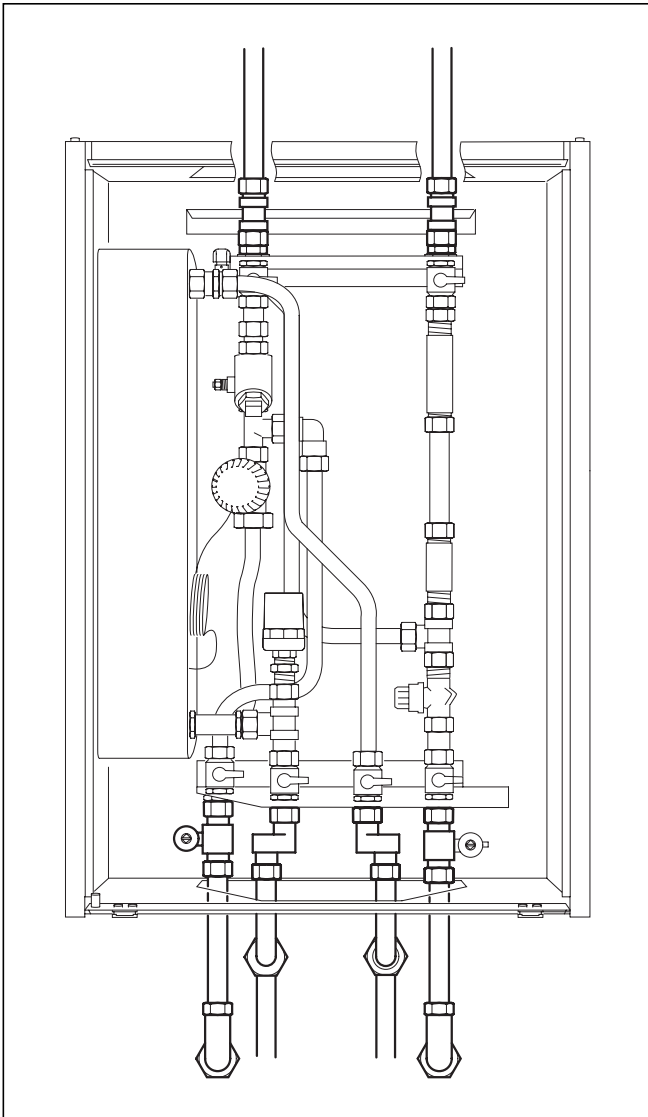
Wasser- und heizungsseitiger Anschluss
